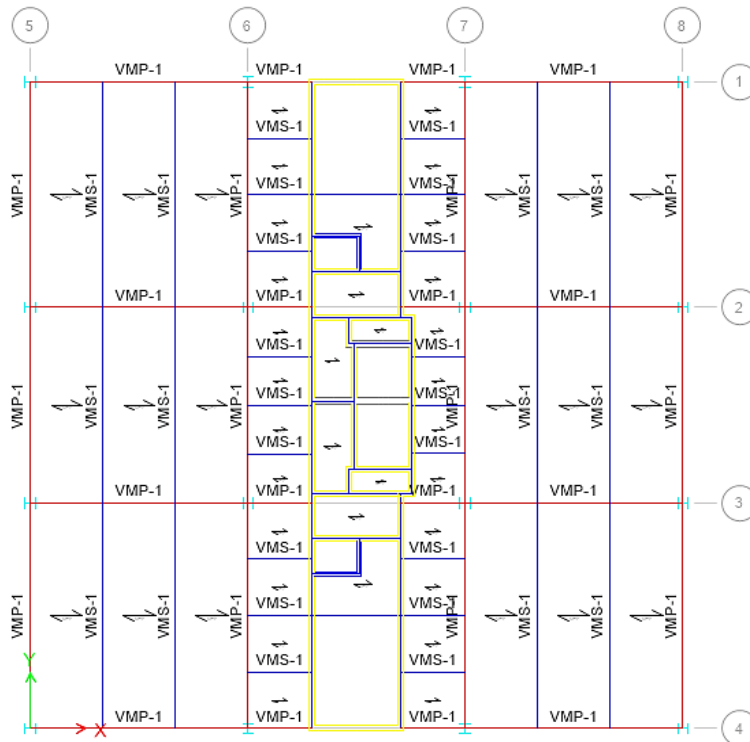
Vista de planta de la estructura A, niveles 1-3.
